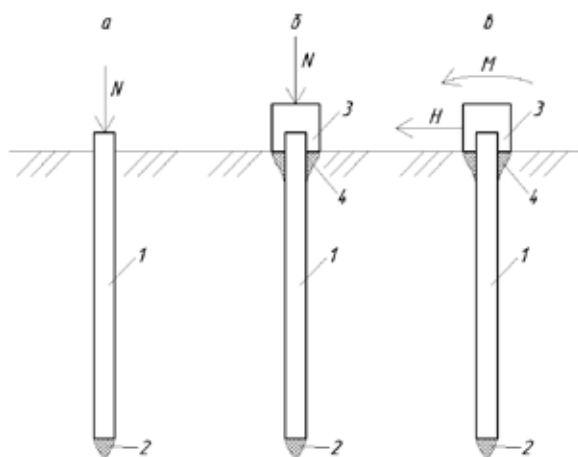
Схемы испытаний: а — одиночной буровой сваи при критической нагрузке, б — односвайно-плитного фундамента при критической вертикальной нагрузке, в — односвайно-плитного фундамента при действии горизонтальной нагрузки и изгибающего момента; 1 — буровая свая, 2 — грунтоуплотнённый тангенсоид вращения, 3 — плита, 4 — грунтоуплотнённый усечённо-пирамидальный тангенсоид
